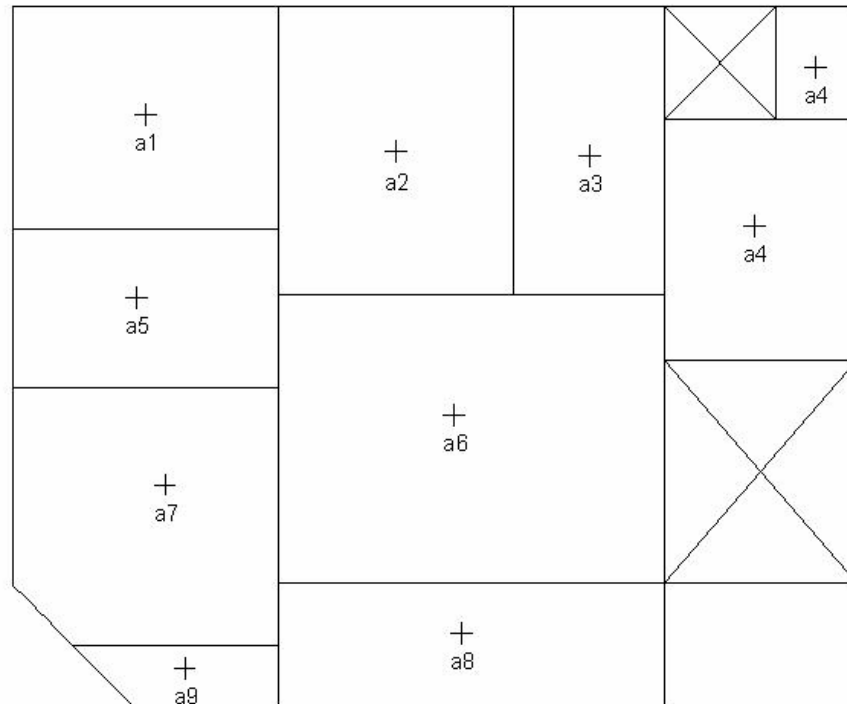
convenção para os deslocamentos máximos das lajes do pavimento.
